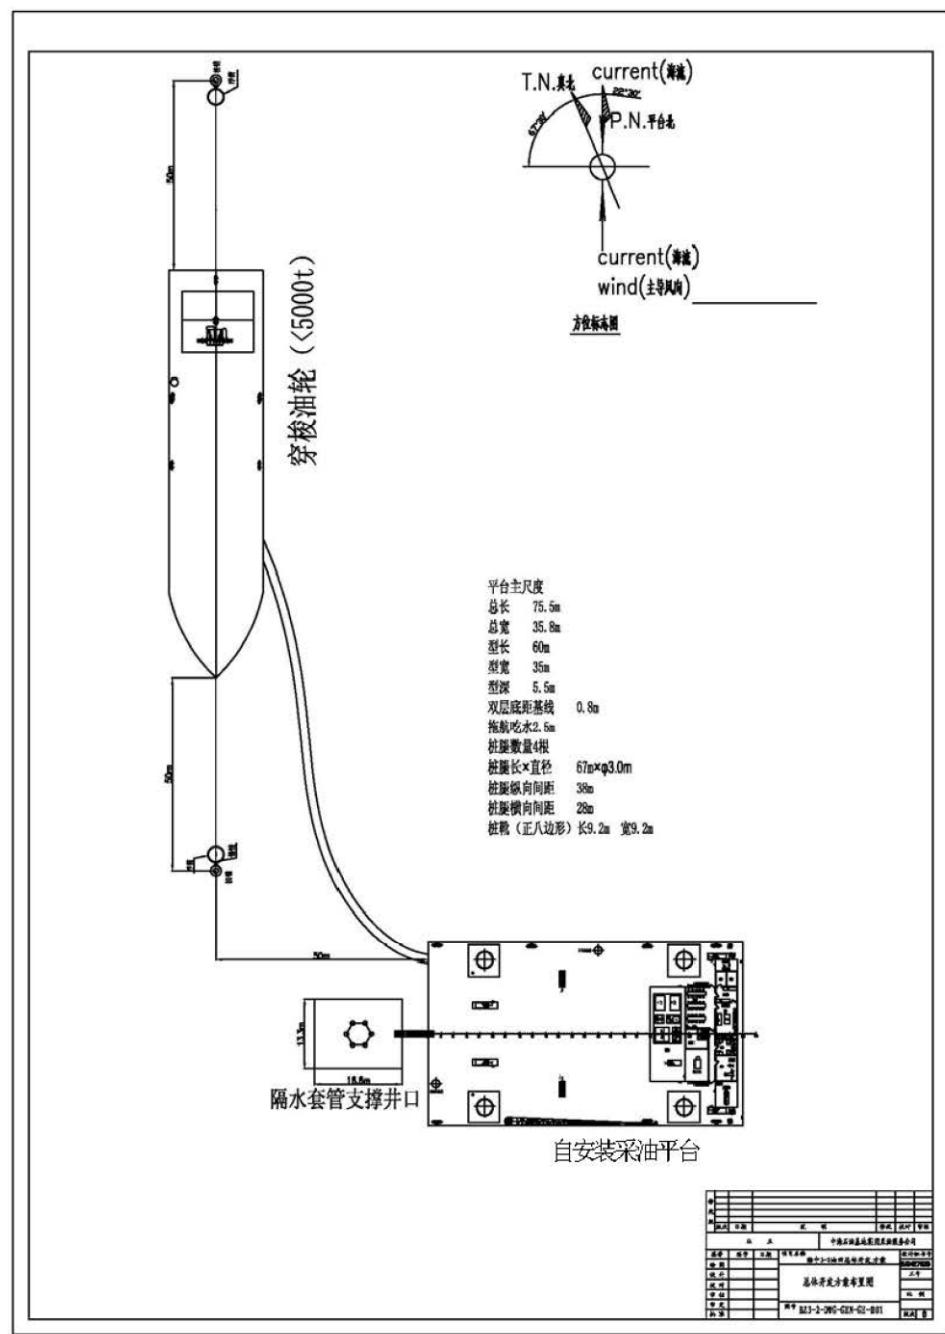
渤中 3-2 油田工程设施平面布置图
